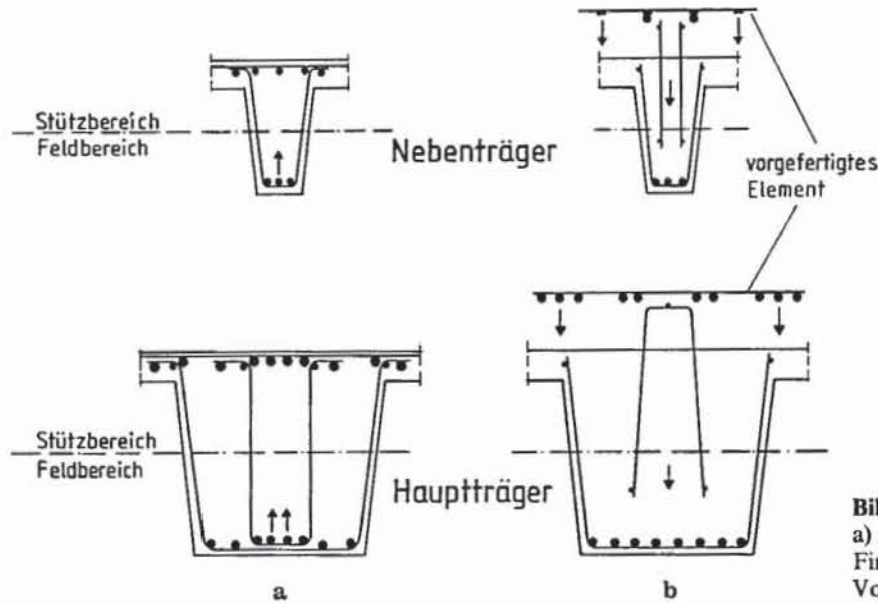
Bewehrung der Haupt- und Nebenträger. a) „Systembewehrung“ der bauausführenden Firma; b) „Rationalisierte“ Bewehrung; Vorschlag der Verfasser
